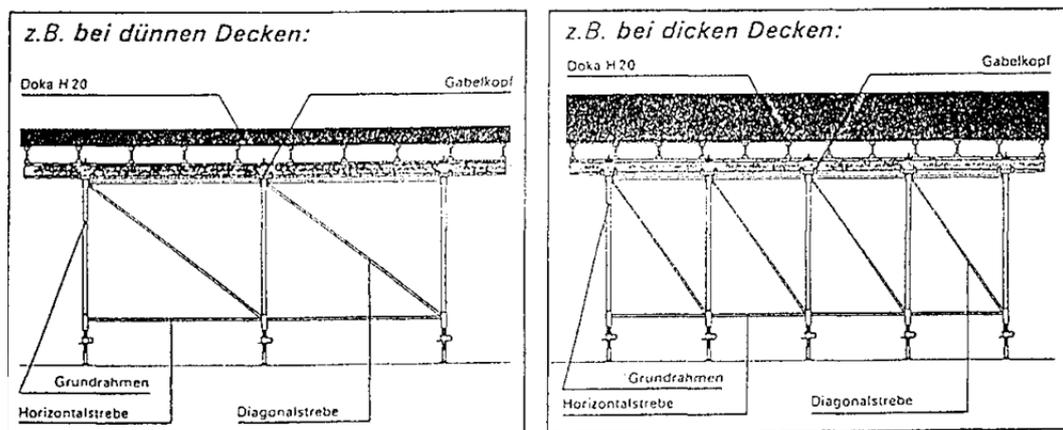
Deckenschalungssystem – Einbau der Tische und Stabilisierungssystem (Einrüstung) [4]
